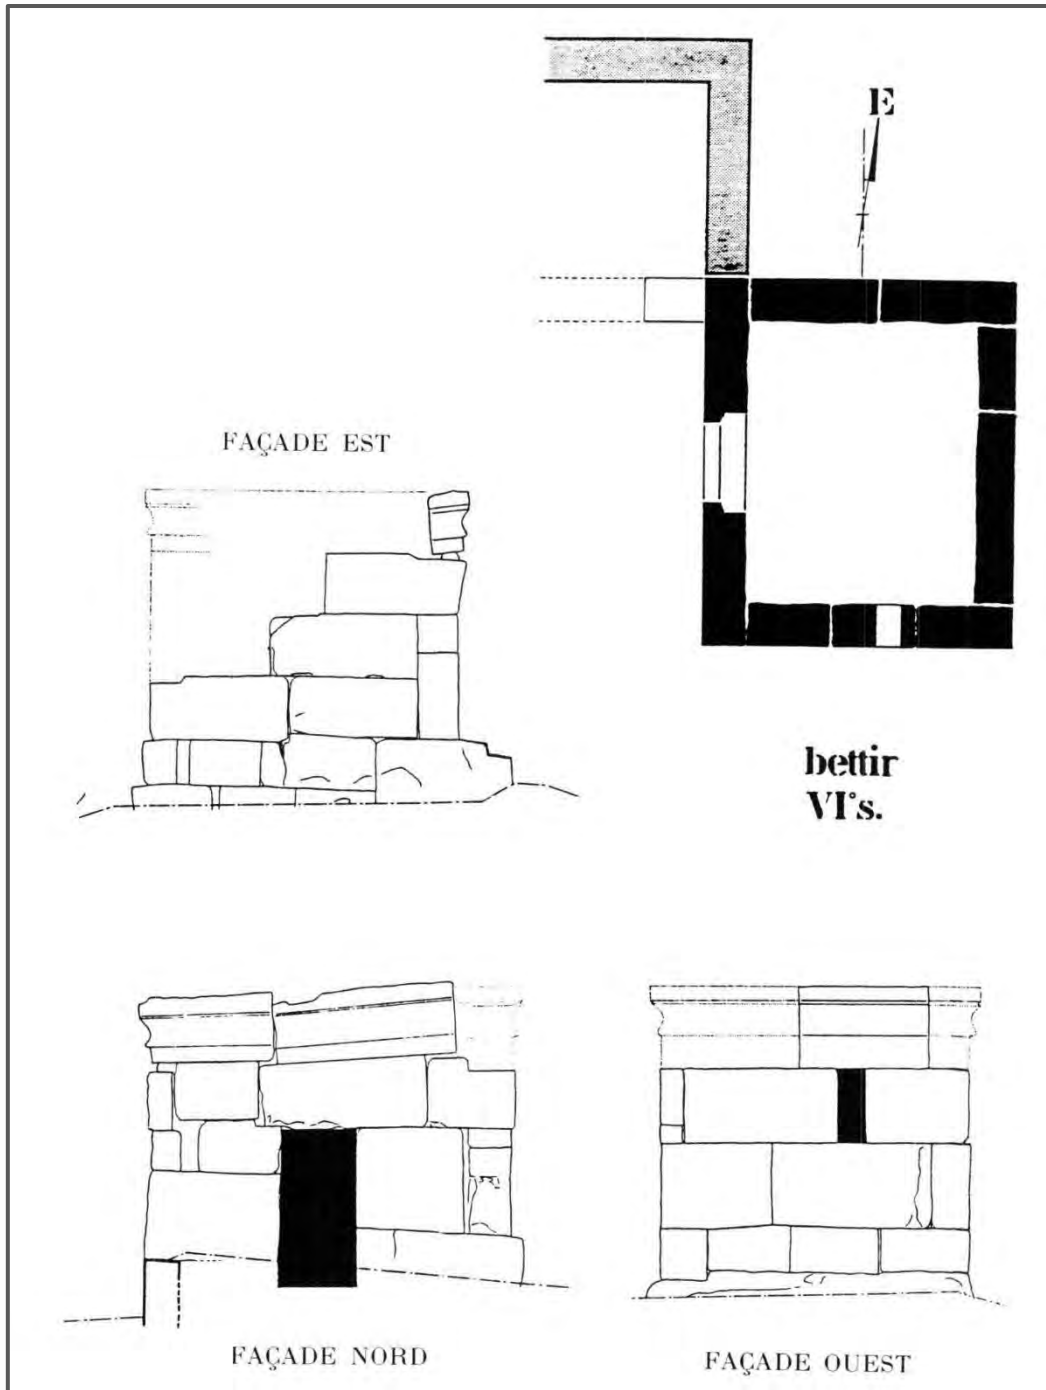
Bettir. Pianta e alzato del battistero (scala 1.90) (Dufay 1988, Tav. VI).
